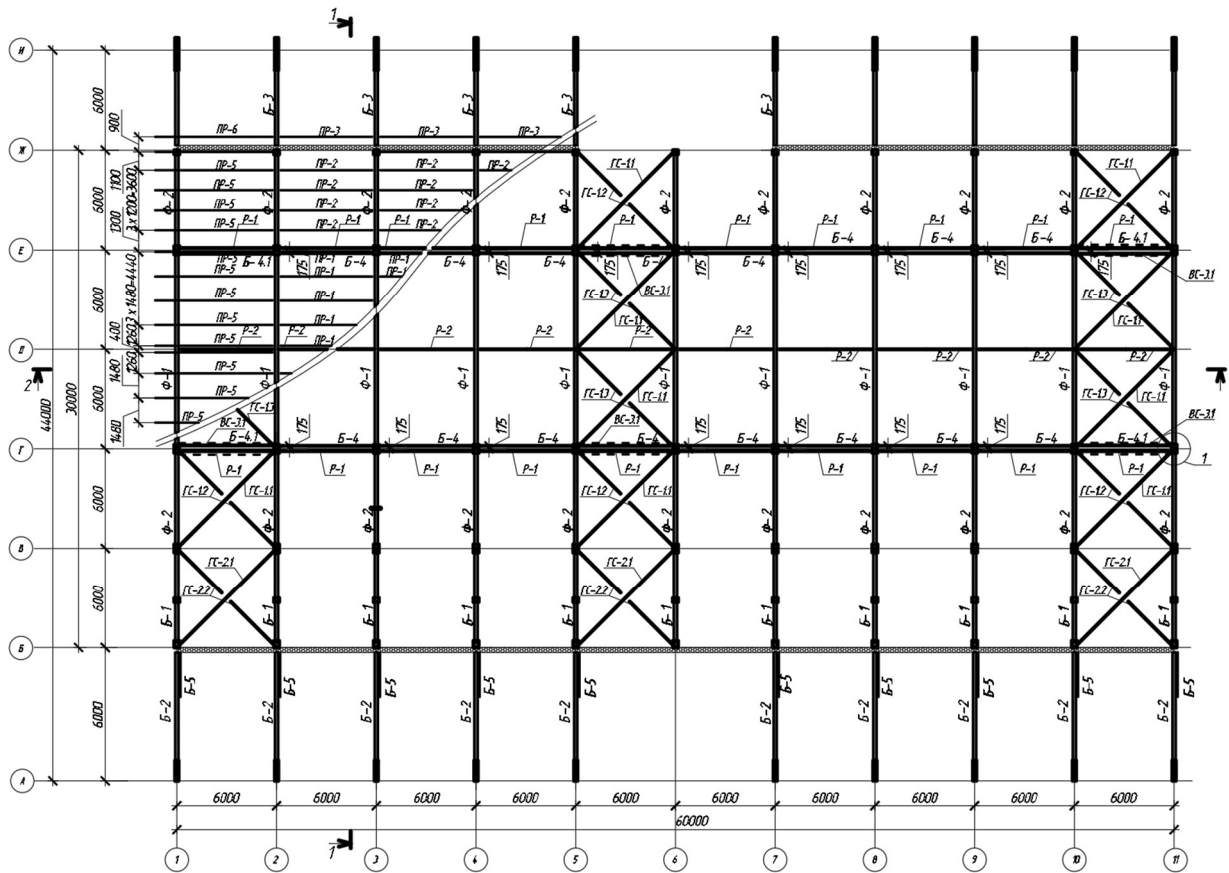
Схема расположения балок, ферм, и связей по фермам
